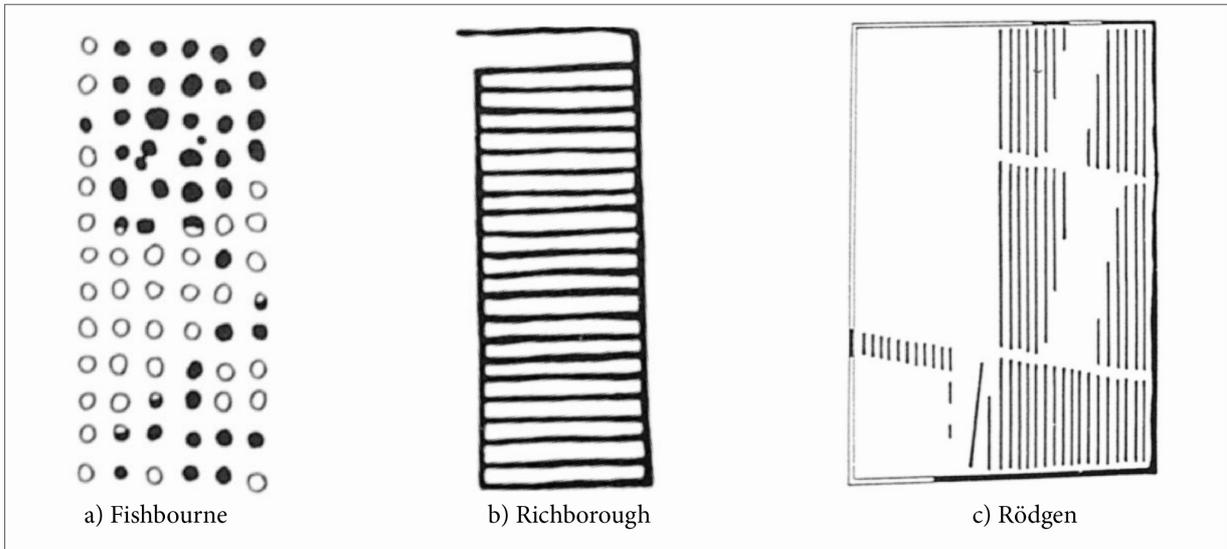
Hölzerne Horrea, Pfostenfundamente bzw. Schwellbalkenauflagen
